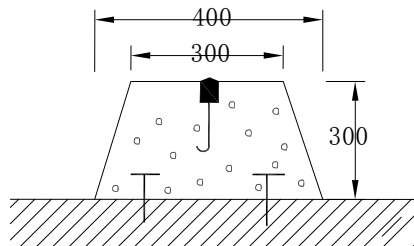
建筑物 CP0 平面控制点标石（单位：mm）
